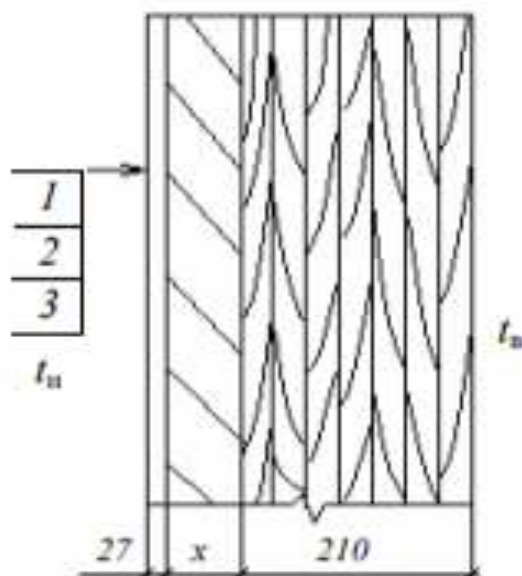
Конструкция стены из клееного бруса с дополнительной теплоизоляцией: 1 - блок-хаус; 2 - теплоизоляционный слой; 3- клееный деревянный брус из древесины сосны
